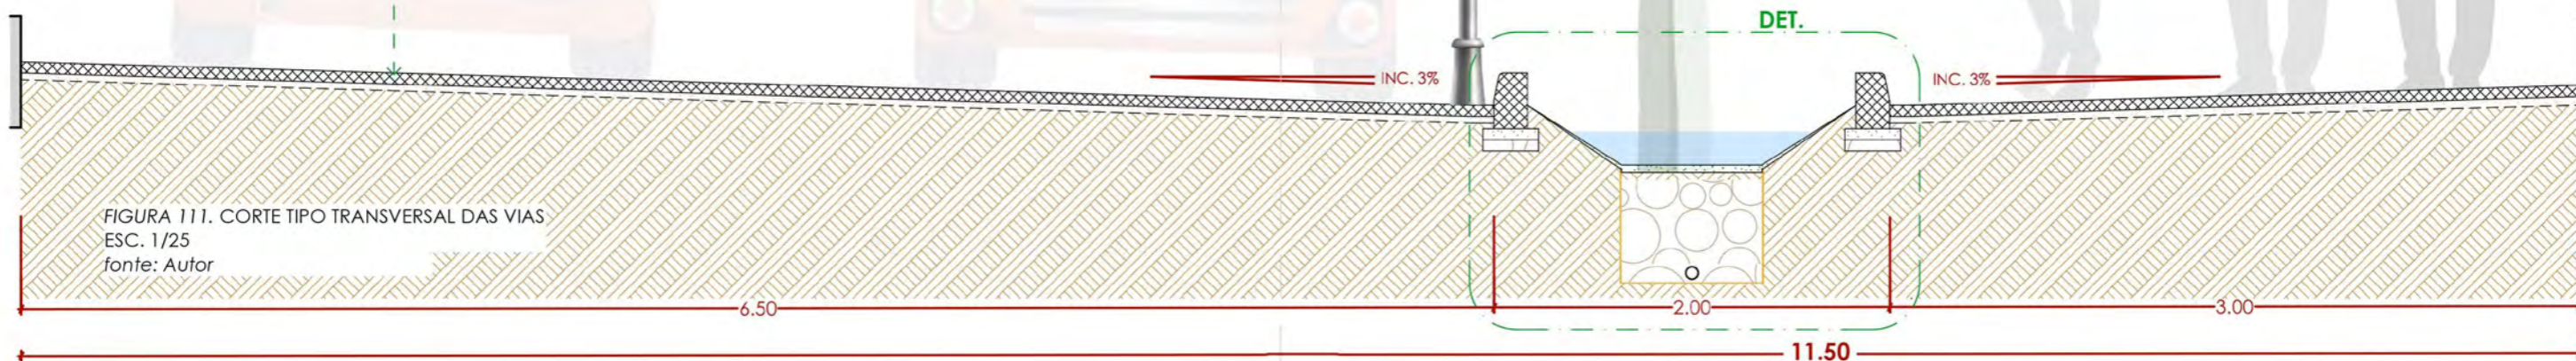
CORTE TIPO TRANSVERSAL DAS VIAS
